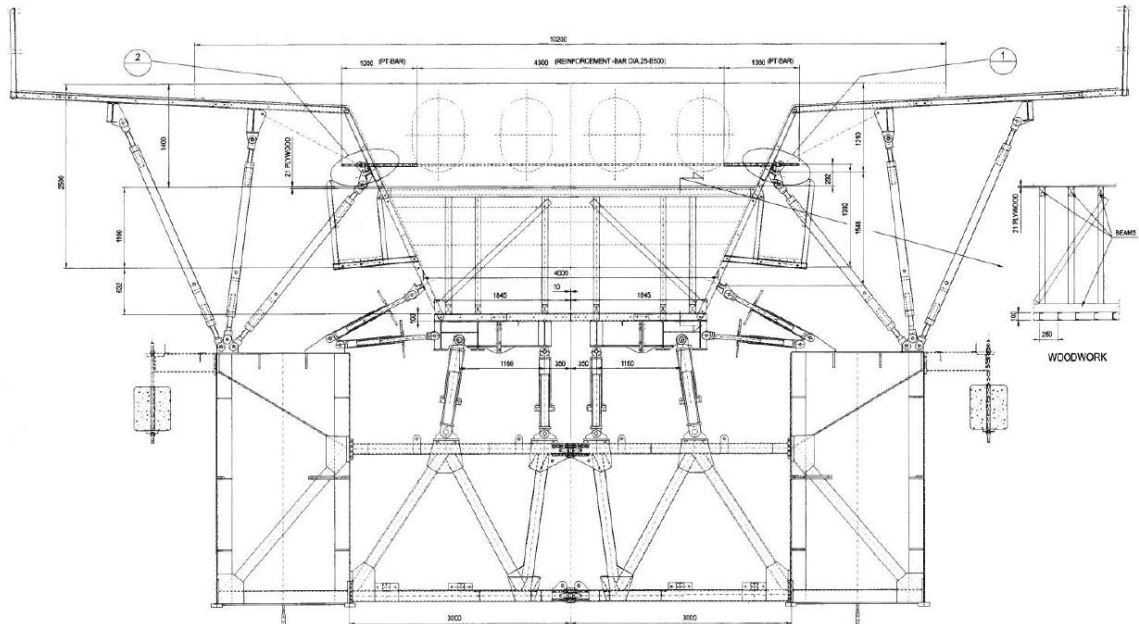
Secção transversal de projecto em fase de betonagem, (Viaduto 1).
